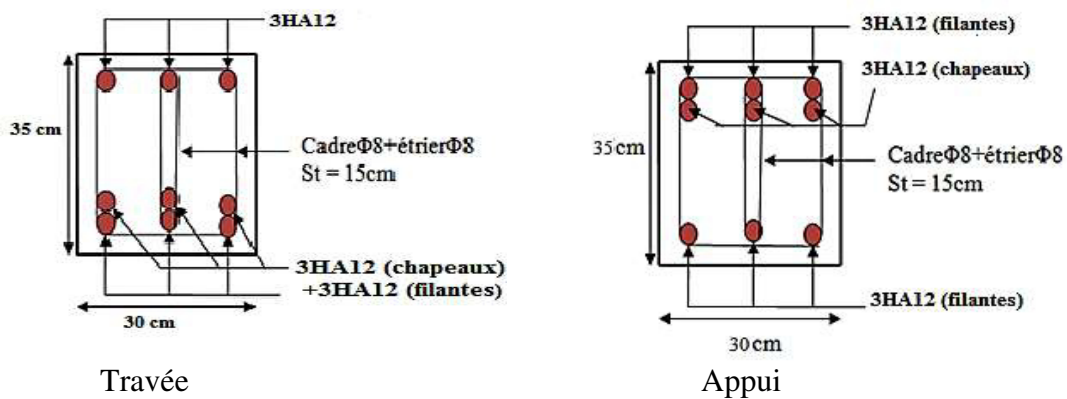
Schéma de ferrailage des poutres secondaires de RDC – 7 étages.
